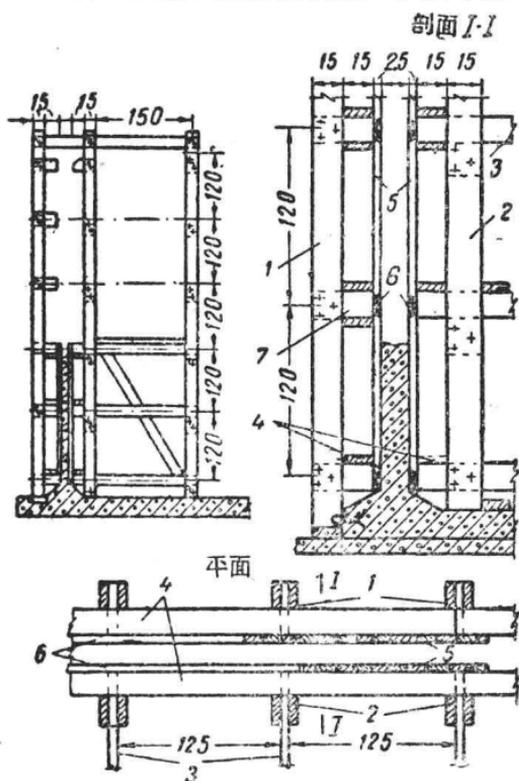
澆灌矩形鋼筋混凝土貯水池用的移置式木模板
